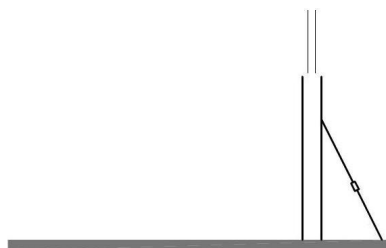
figura esquemática das fôrmas dos pilares e prumo
